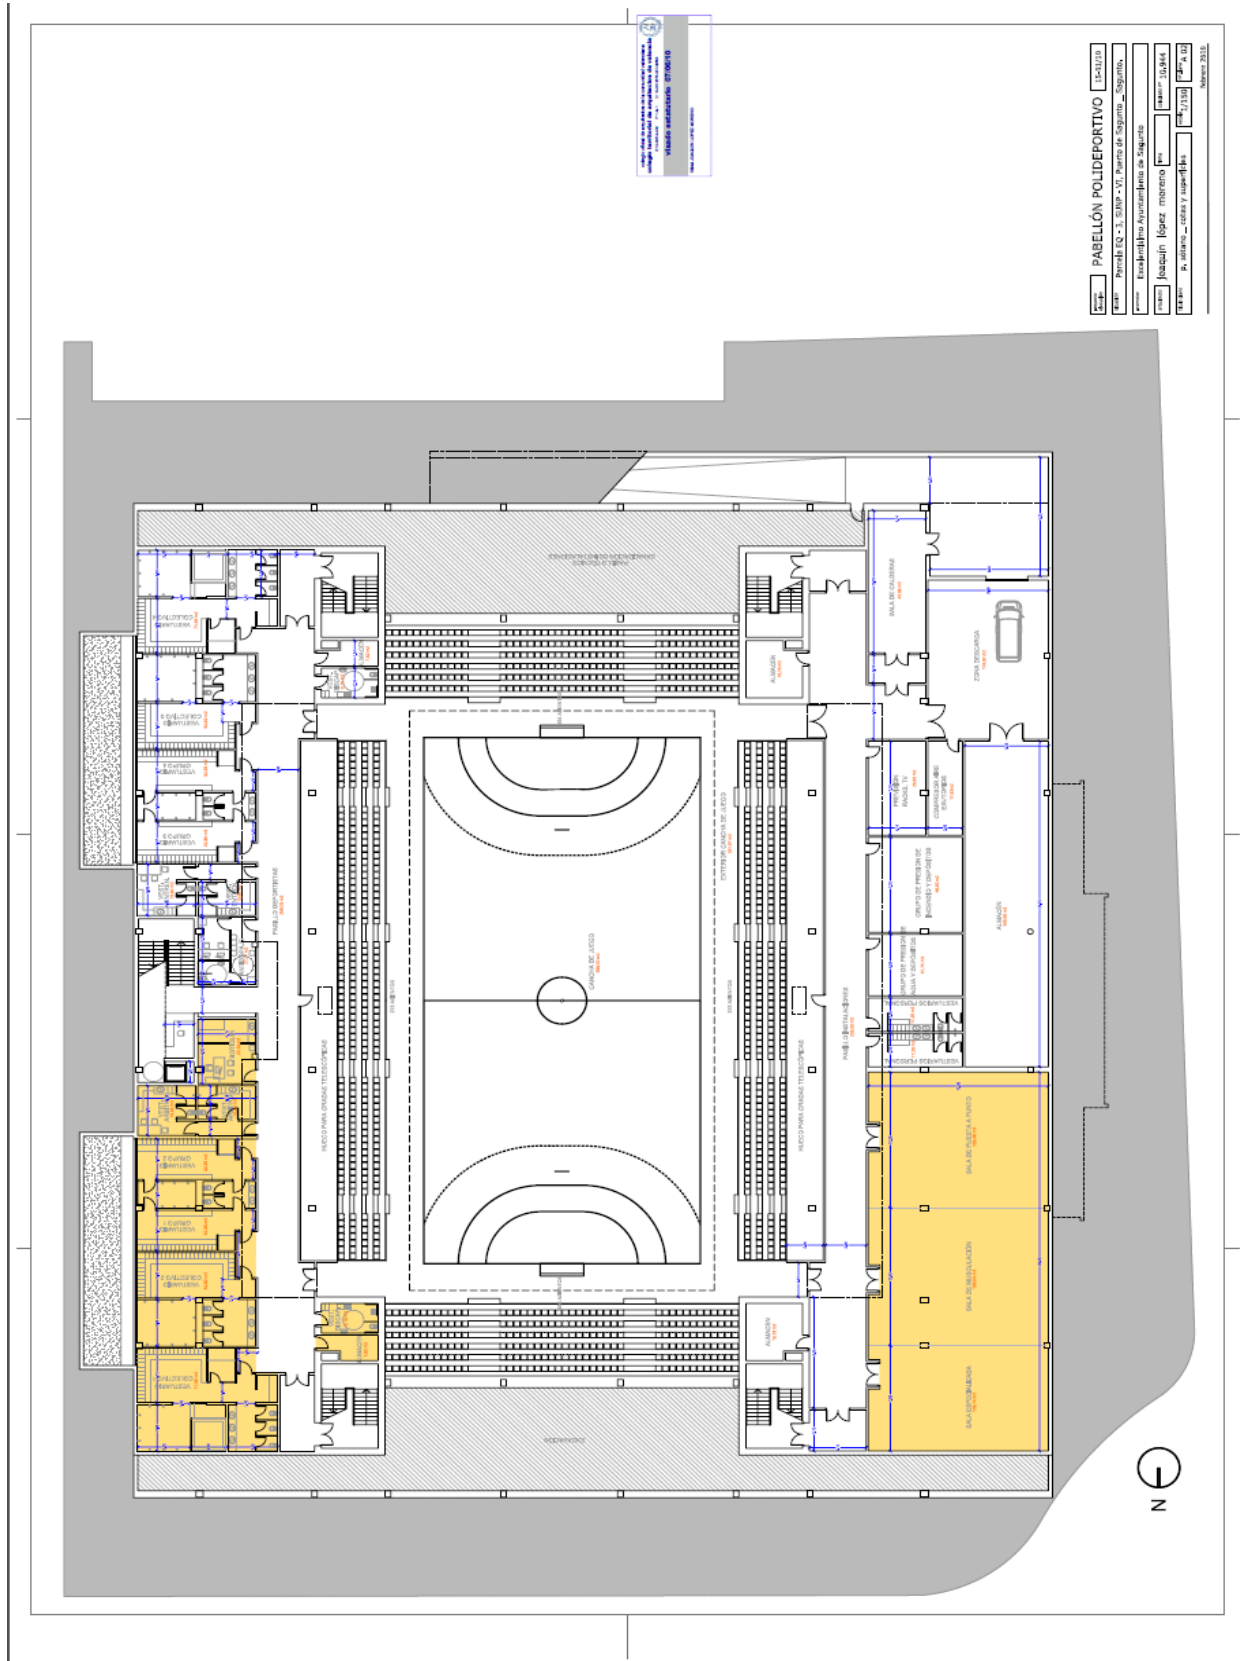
Plano sótano Pabellón. Fuente: Proyecto de Ejecución.
